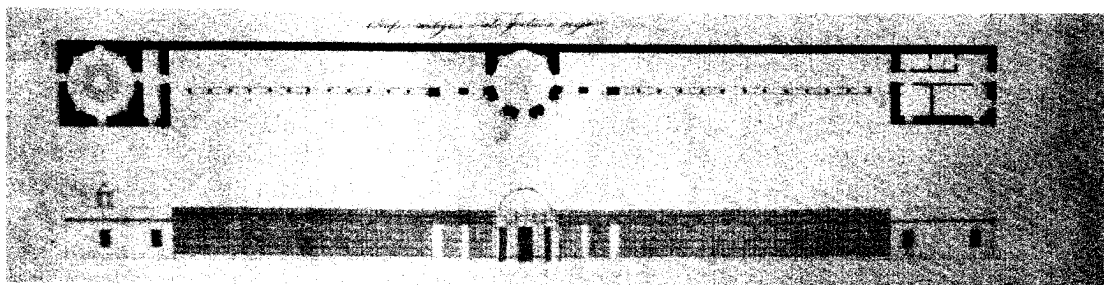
"Estufa" de Vista Alegre, planta y alzado (Narciso Pascual y Colomer, A.G.P., plano nº 3517, diciembre de 1845).
